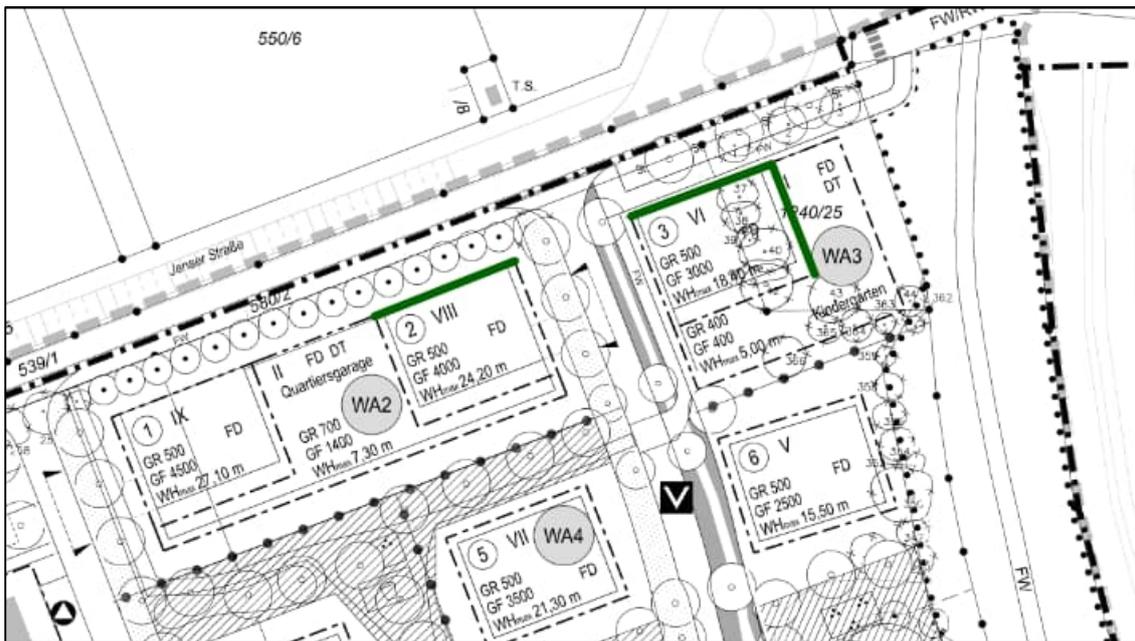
Lageplan mit Kennzeichnung der Fassadenbereiche, an denen Immissionsgrenzwertüberschreitungen (auf den jeweiligen Obergeschossen) zur Tagzeit prognostiziert werden
